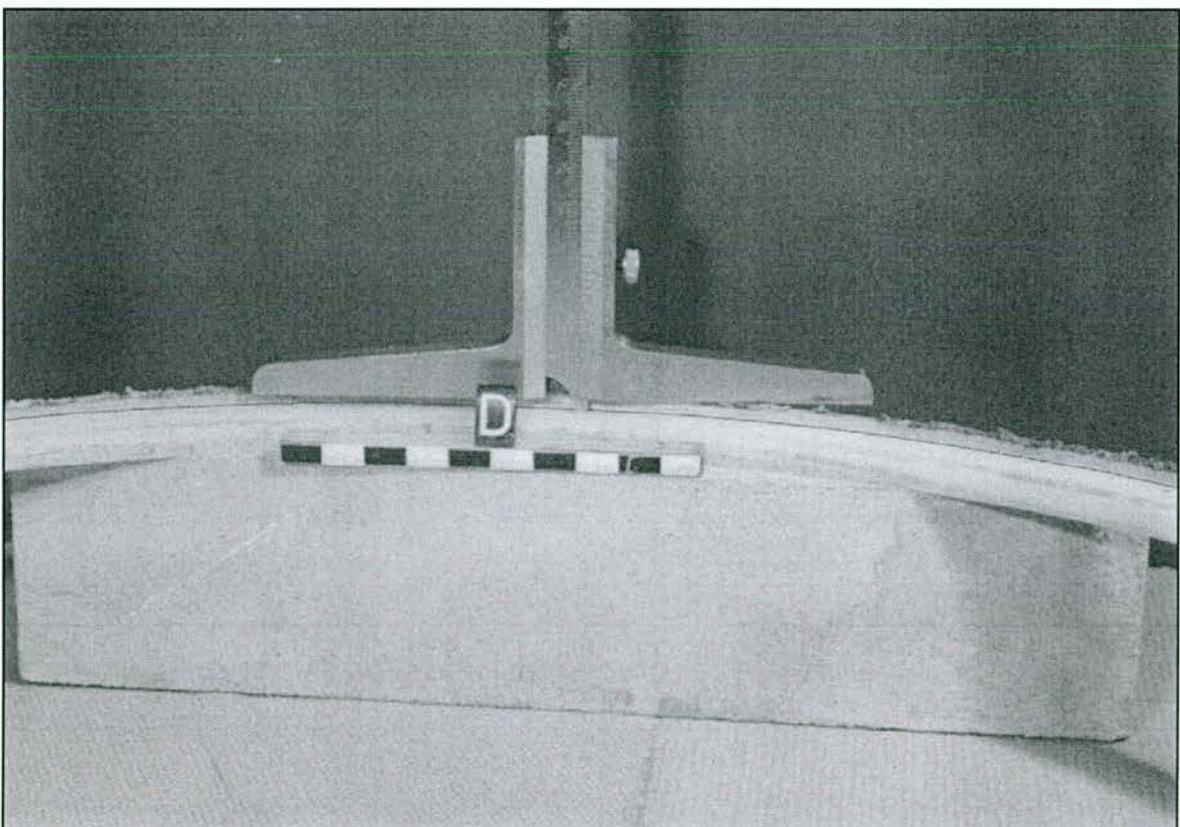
UHMWPE-Innendichtung nach dem Langzeit-Belastungsversuch: Detailaufnahme bei Stelle D (mit gesamtem Lagerspiel, Wulstkontur nachgezeichnet)
